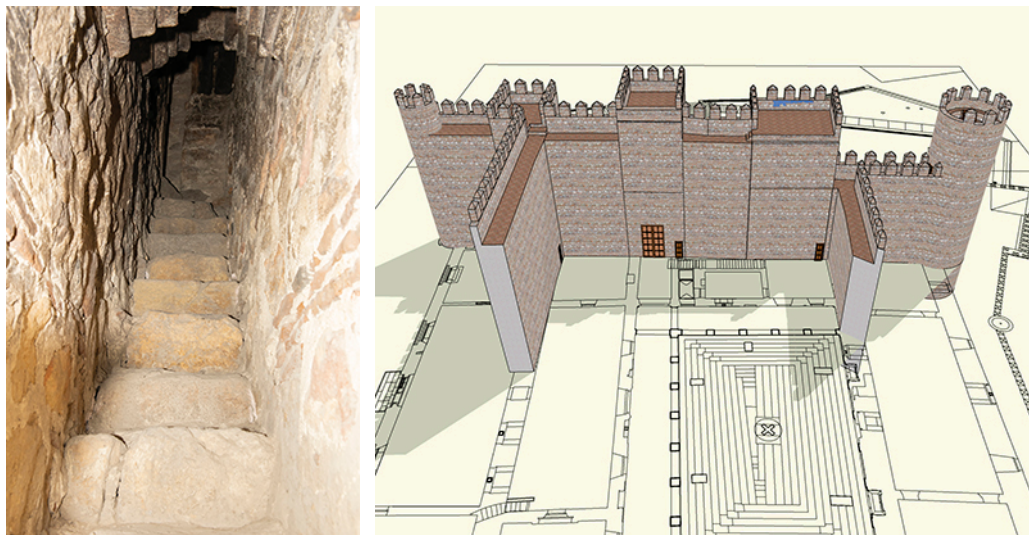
Escalera de ingreso entre muros de mampostería encintada con falsas bóvedas de ladrillo.
